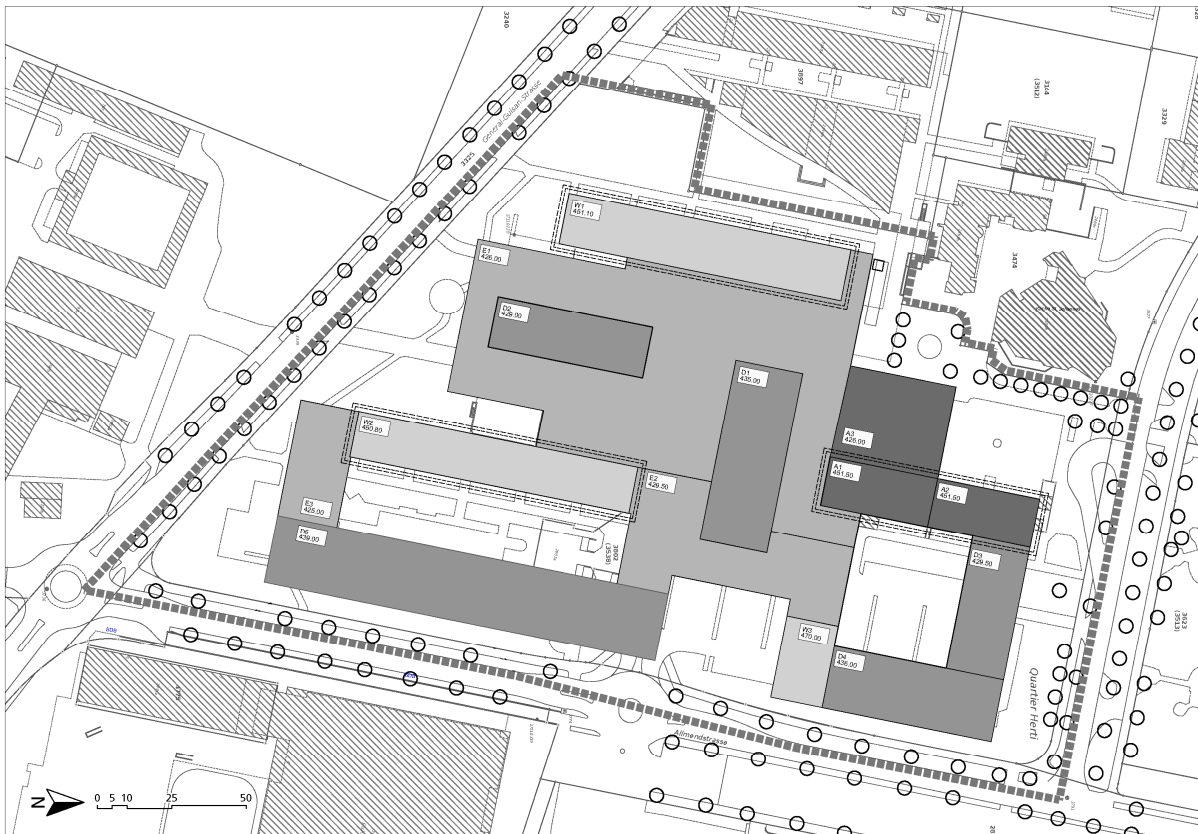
Übersicht aller Baubereiche gemäss Situationsplan vom 21.09.2016, Quelle Baudepartement
